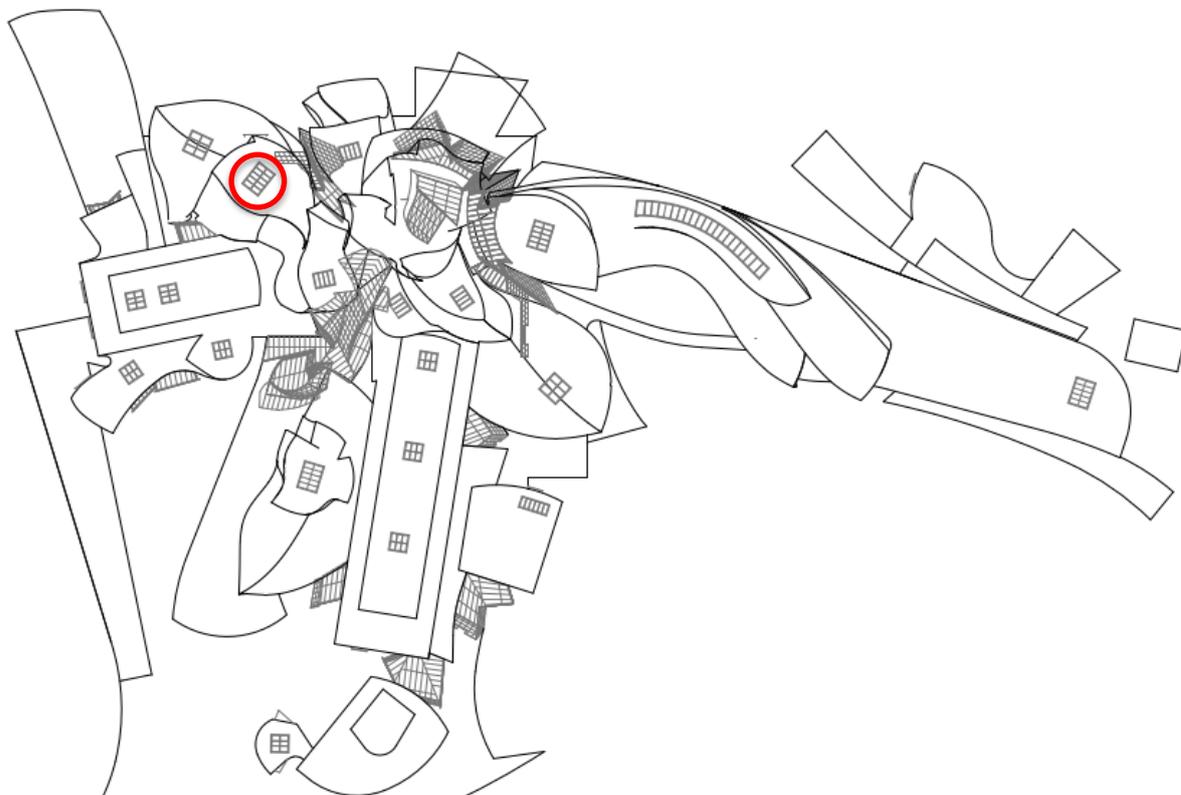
Ubicación de trampilla para controladores en 302 (bajo).
